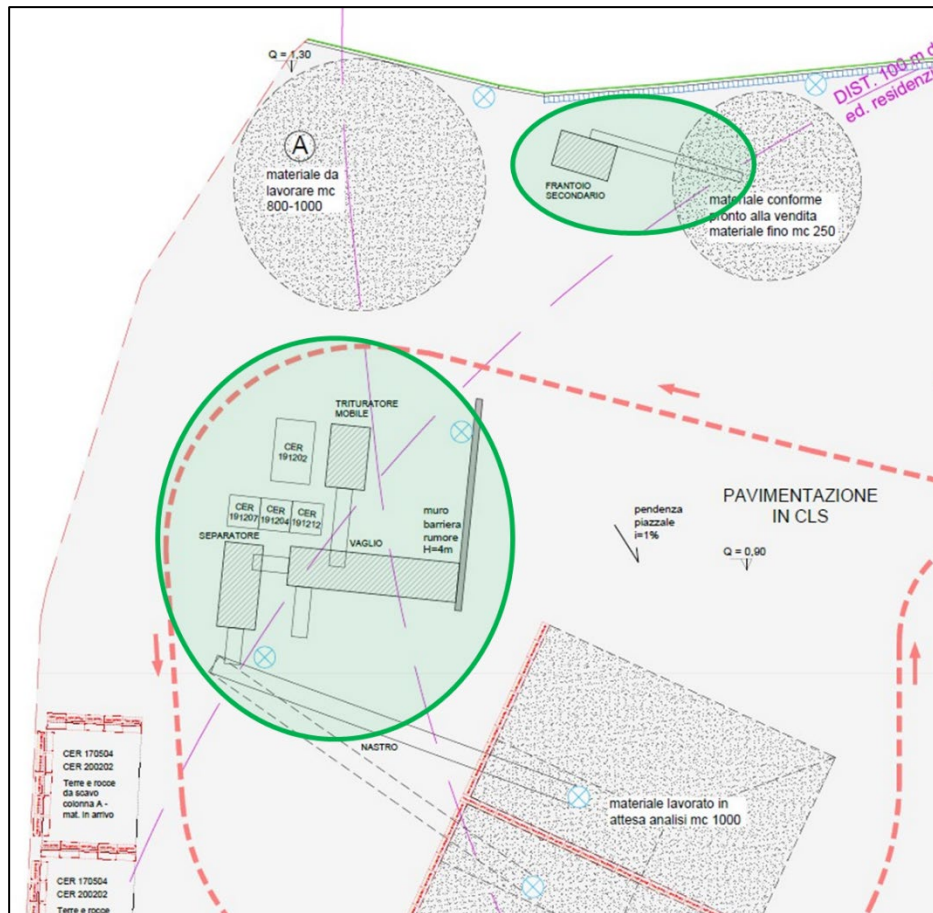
Estratto Allegato 2.2 allo SPA - Layout impianto – Posizione dei macchinari all’interno dell’area d’impianto
